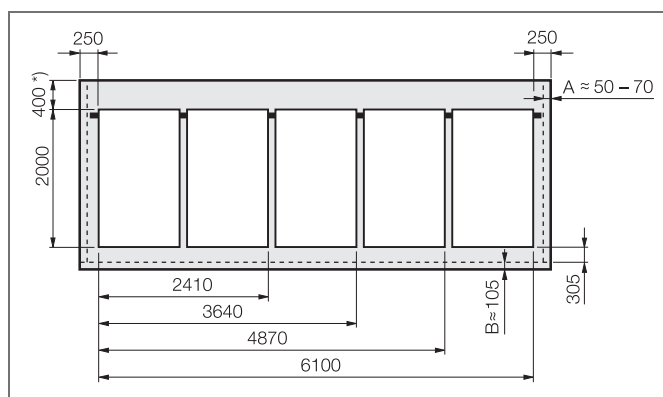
Außenmaße des Kollektorfelds bei Auf-/Indachmontage des Rahmenkollektors (einschließlich Einblechung)
